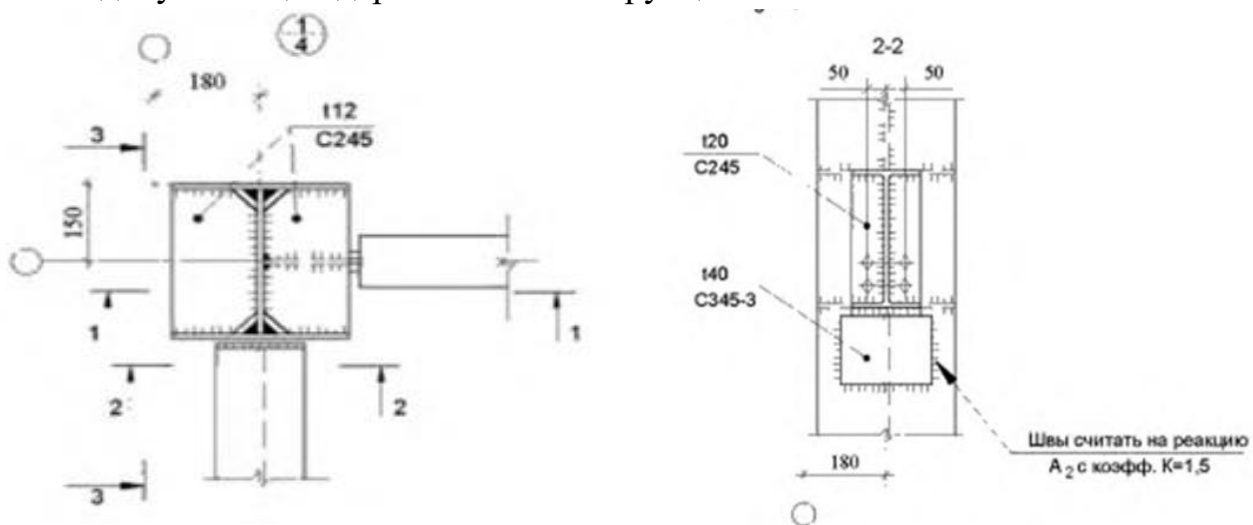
Пример выполнения чертежа узла металлической конструкции
